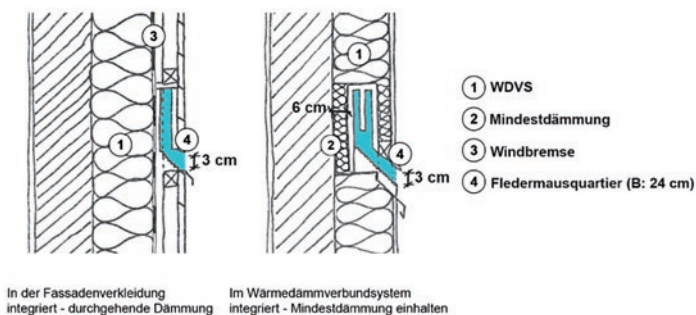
Fledermausquartiere in der Fassade (o. M.) (Quelle: In Anlehnung an: Gunnell, Kelly/ Murphy, Brian/ Williams, Carol: Designing for Biodiversity - A technical guide for new and existing Buildings. 2. Auflage. London: RIBA Verlag 2013. S.111. Abb. 18.)
